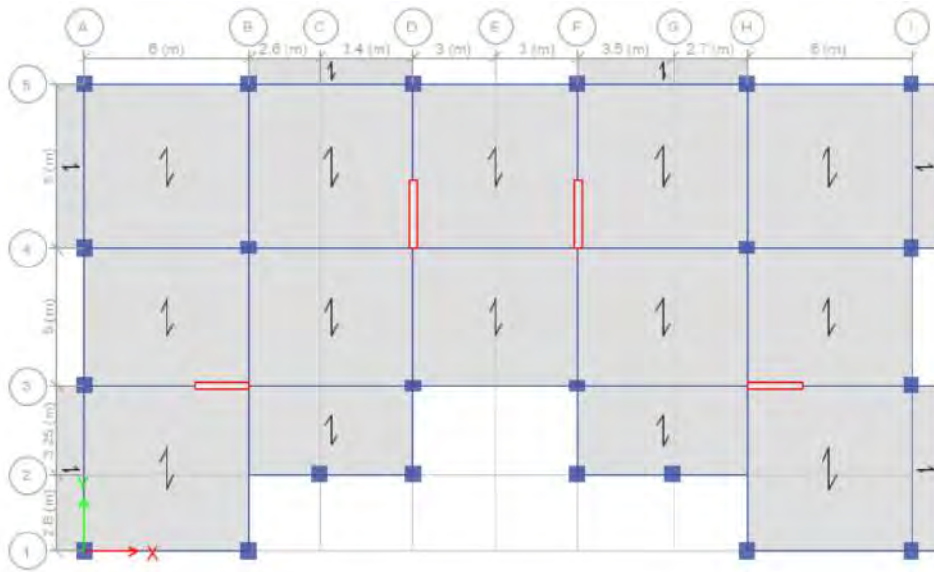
Planta del modelo reforzado con encamisados de concreto armado
